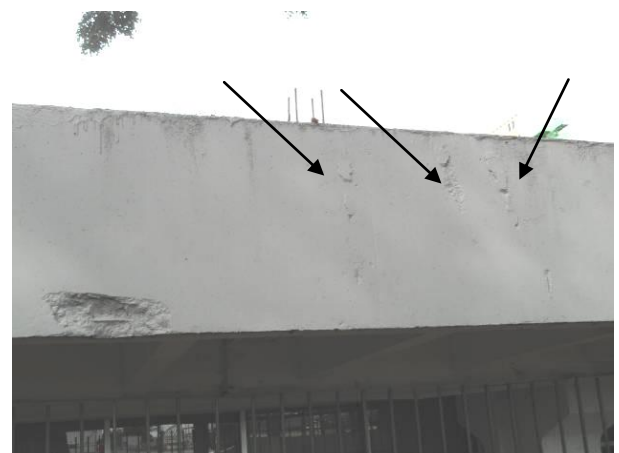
Concreto disgregado com armadura exposta na face C da Viga de borda do lado C, entre os eixos I/J.
